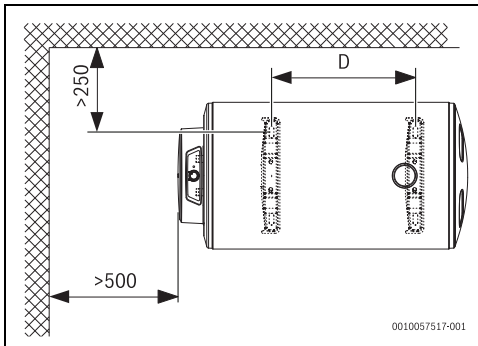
Dimensiones en mm (montaje en pared, instalación horizontal)
